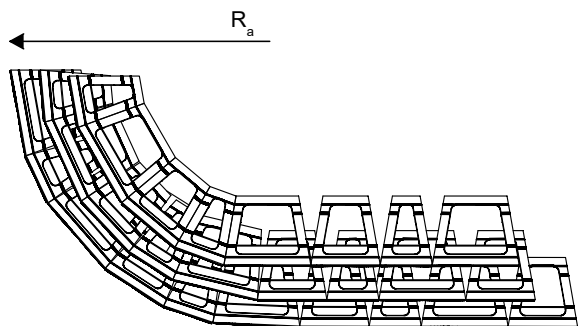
Grundriss Aussenkurven mit Rücksprung 16,5 cm
